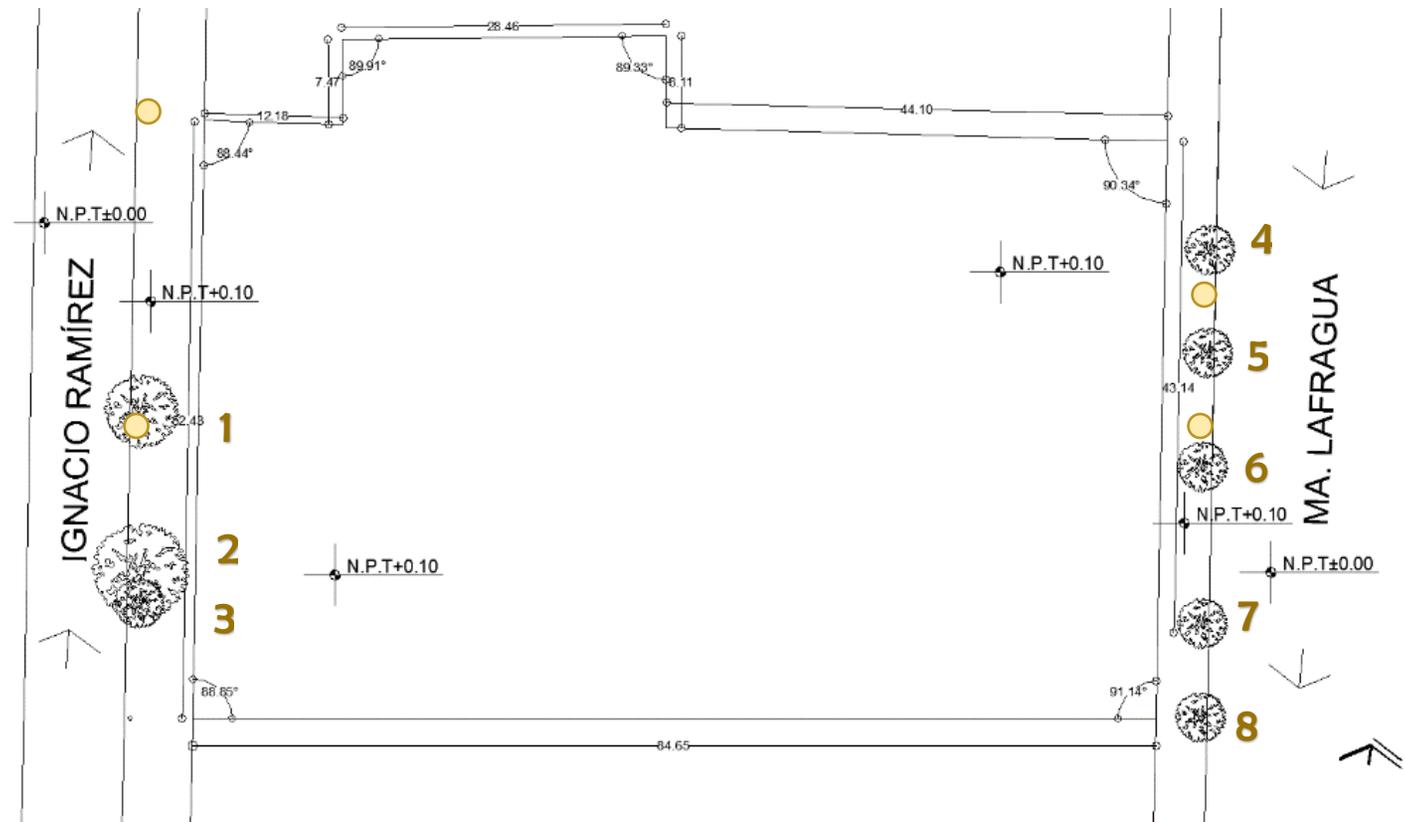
Plano Topográfico Fuente: Elaboración Propia
